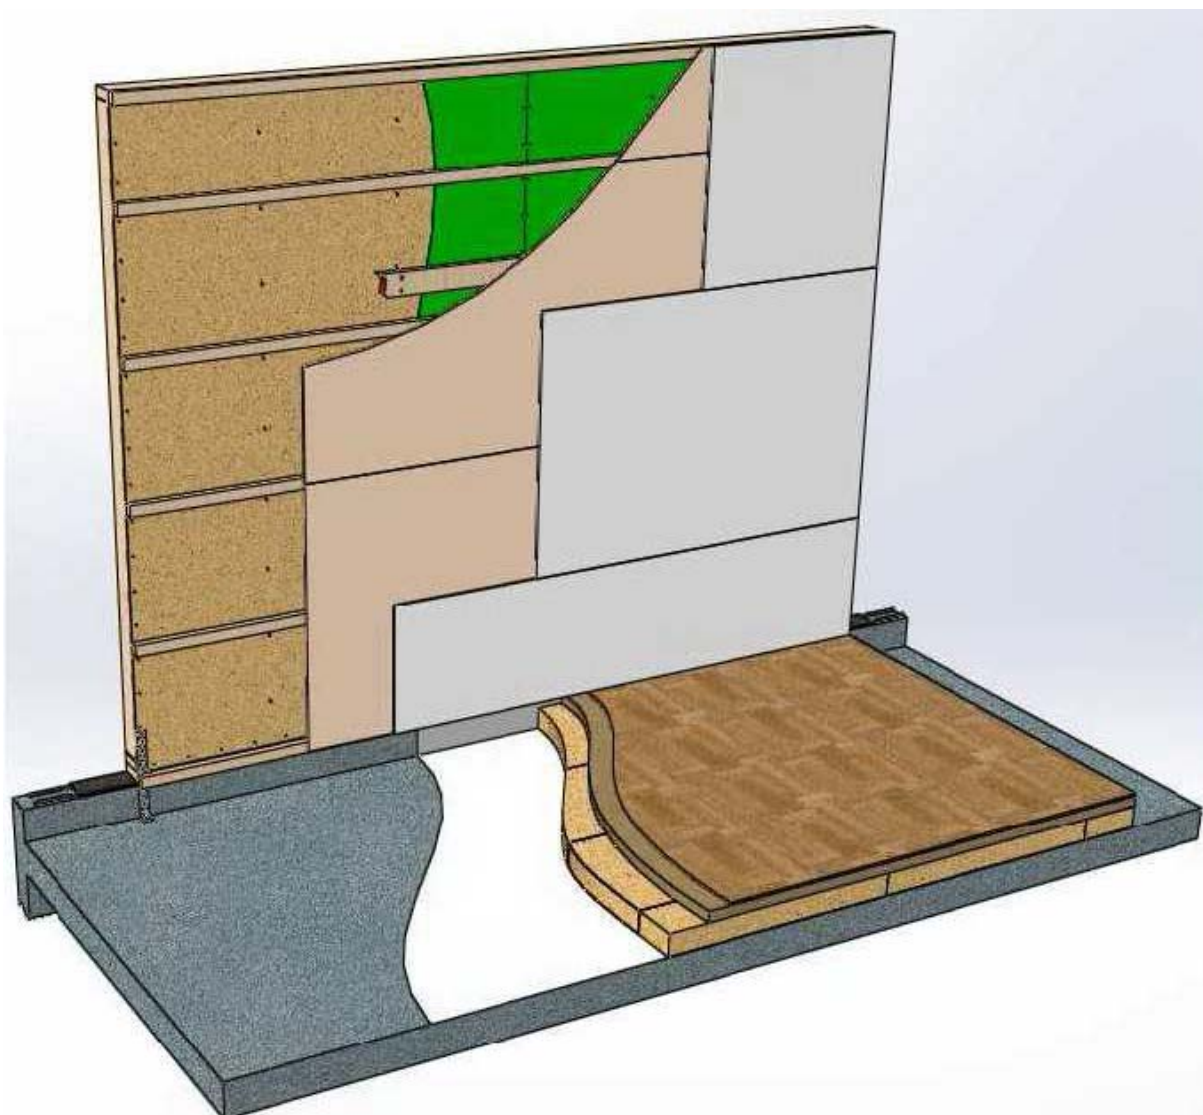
Mur avec revêtement intérieur sur ossature secondaire bois rapportée horizontalement
